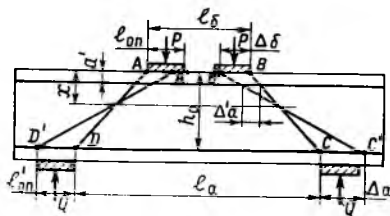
Кинематическая схема для определения высоты сжатой зоны над наклонной трещиной
